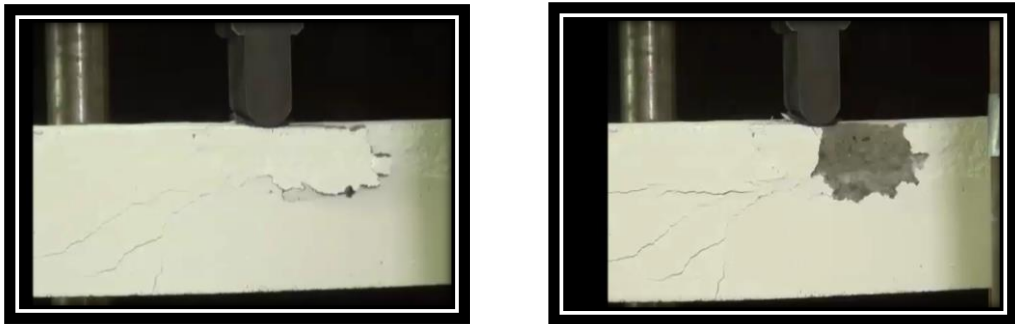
Fisuras en vigas sobre-forzadas.
